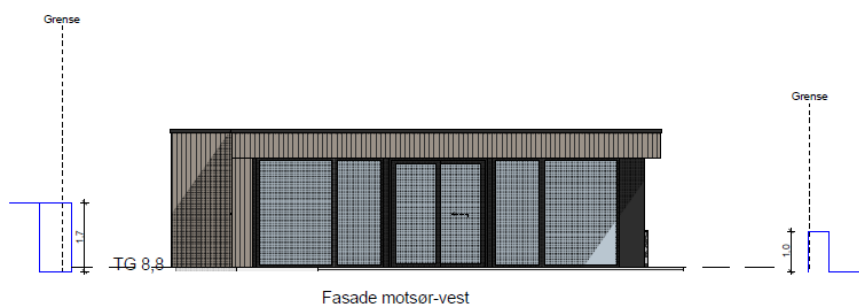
Utsnitt av byggetegninger som viser planlagt gulvhøyde på bolighuset.
